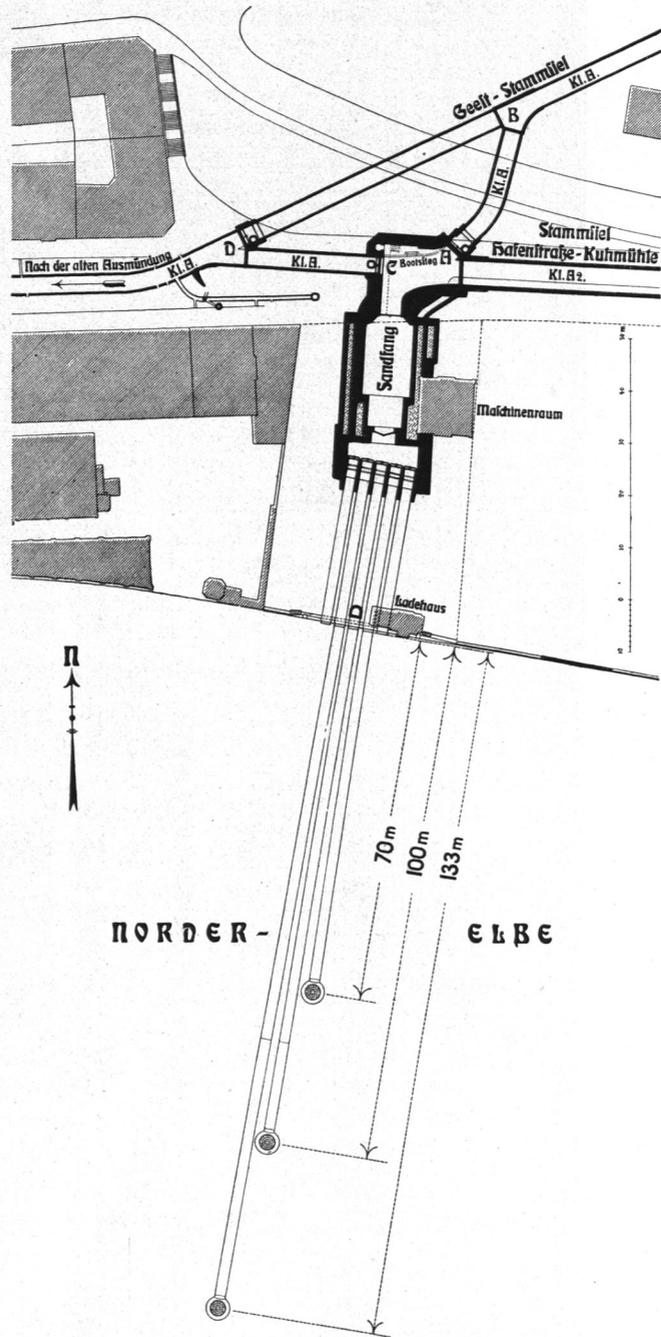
Ausmündungsanlage des nördlichen Elbusfers, Lageplan.
